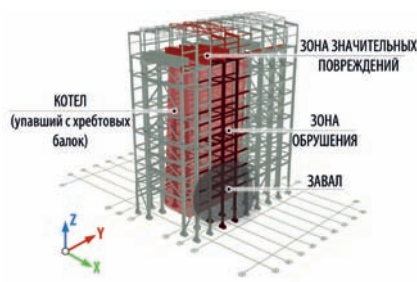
Несущий каркас главного корпуса энергоблока № 3 (источник: [4])
